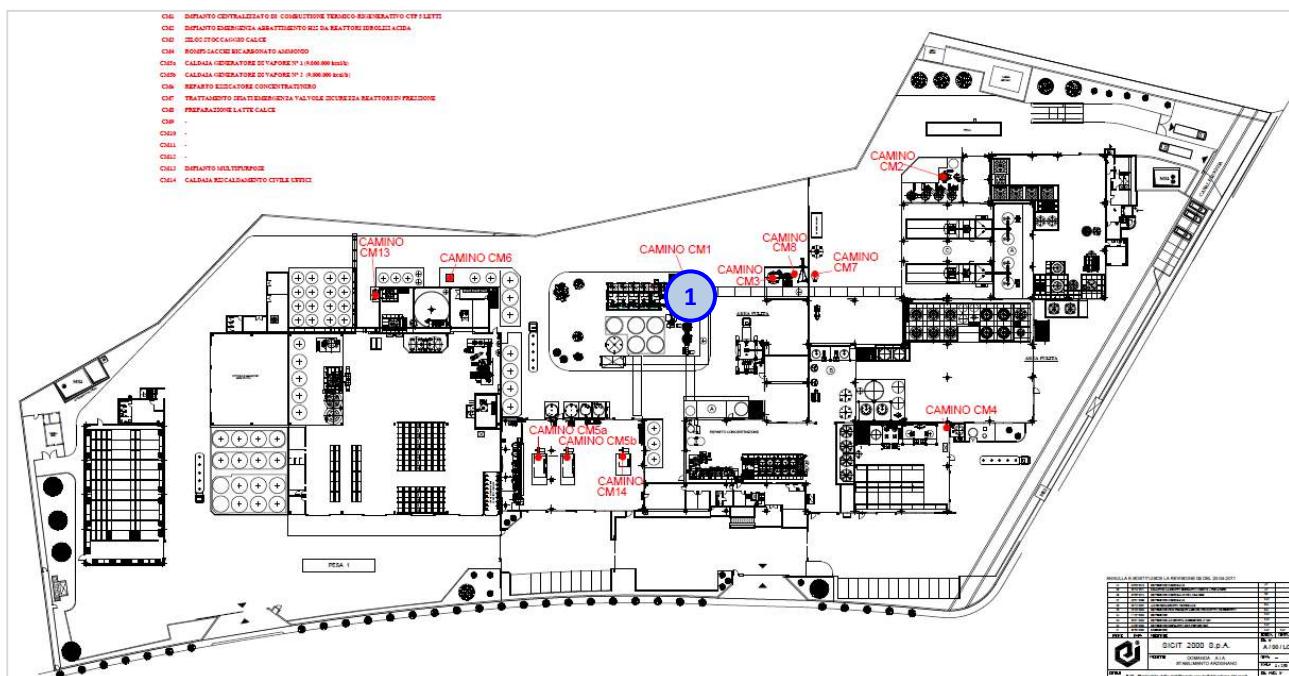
Planimetria dell'impianto SICIT 2000 S.p.A.
